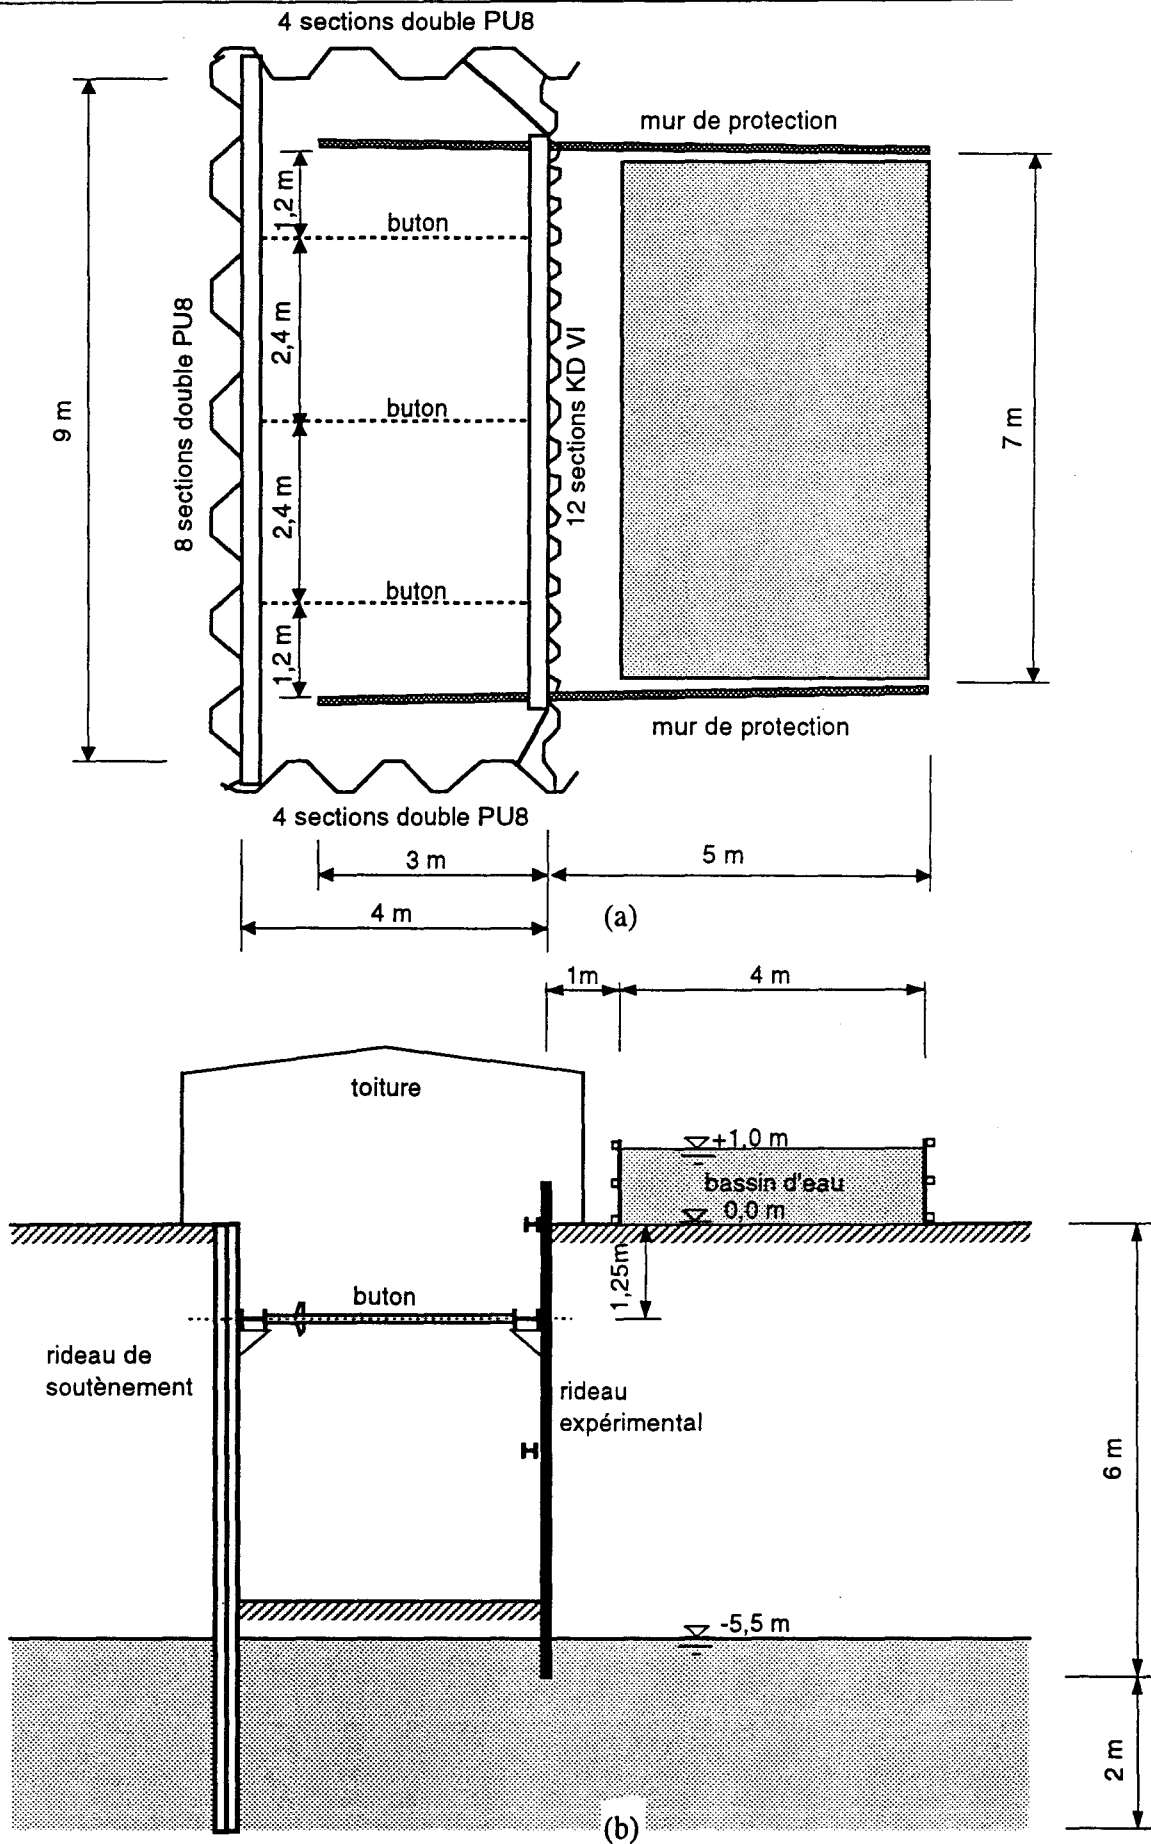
Site expérimental a) Vue en plan b) Section transversale
